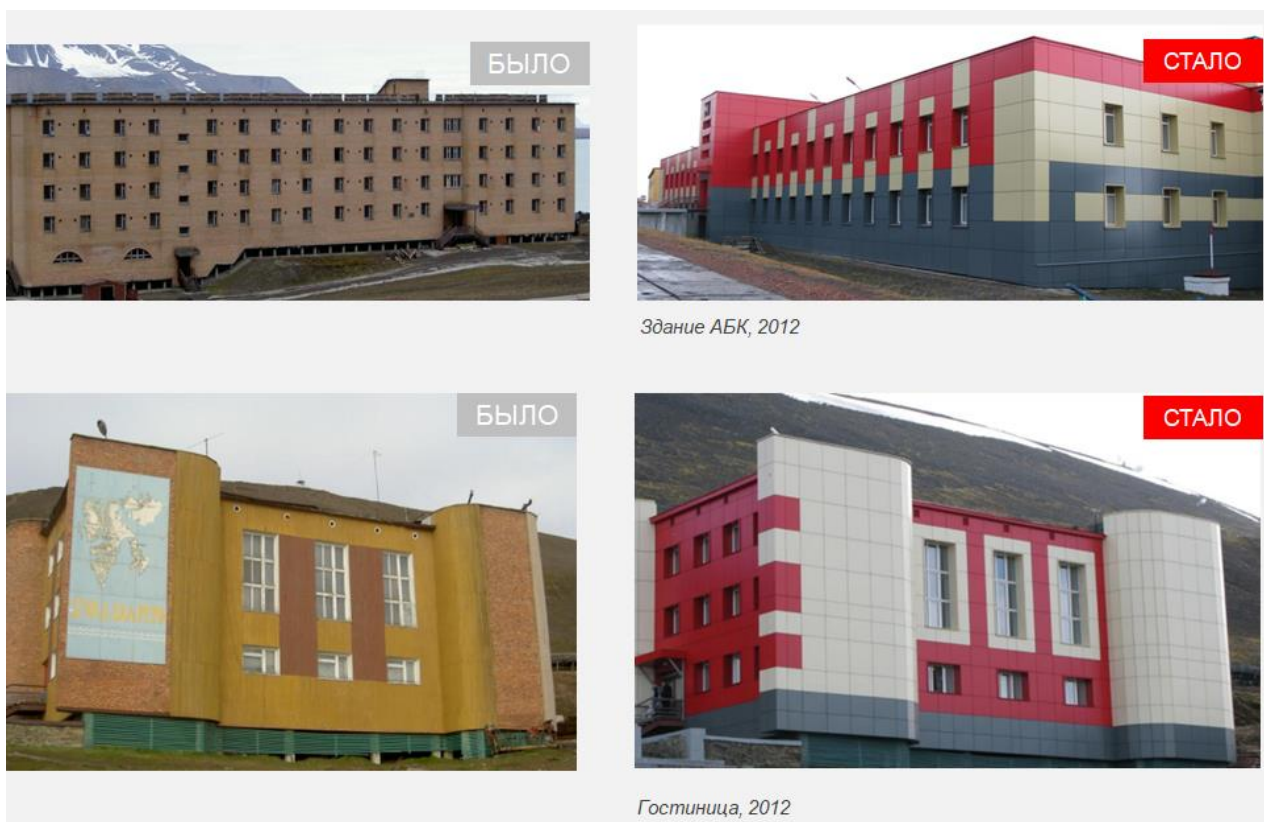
Утепление фасадов зданий г. Баренцбург
